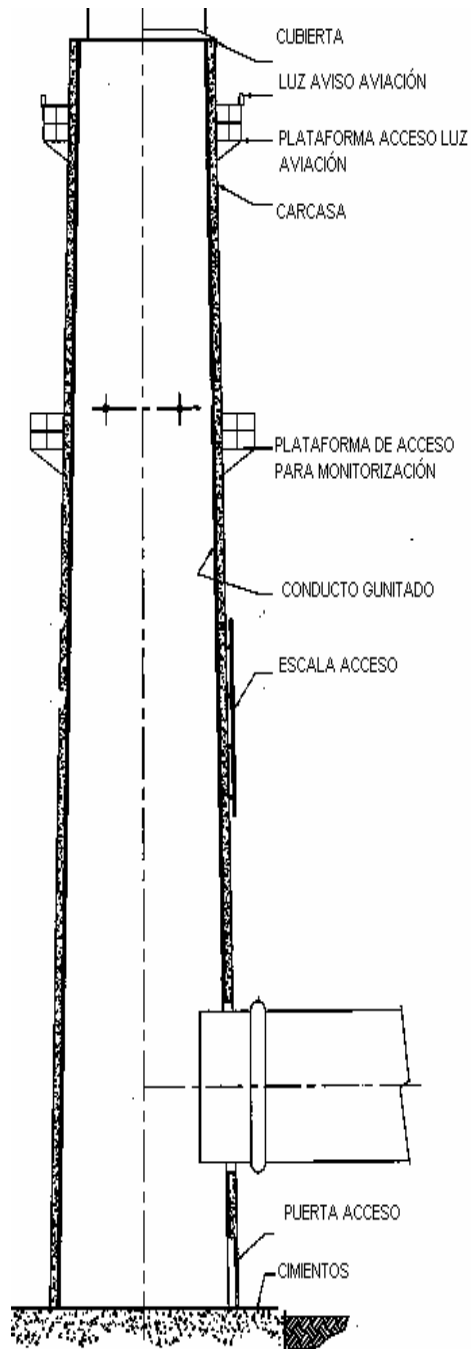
Chimenea de material refractario proyectado sobre pared de hormigón
